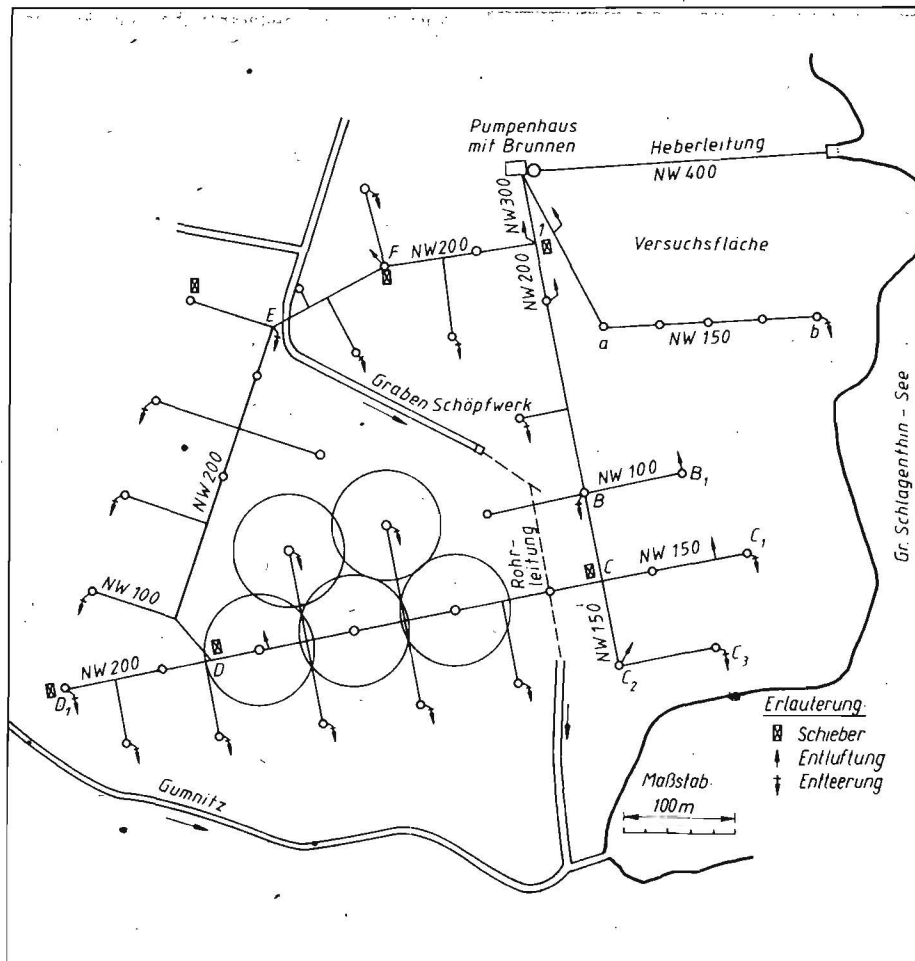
Lageplan der ortsfesten Beregnungsanlage Müncheberg-Schlagenthin
